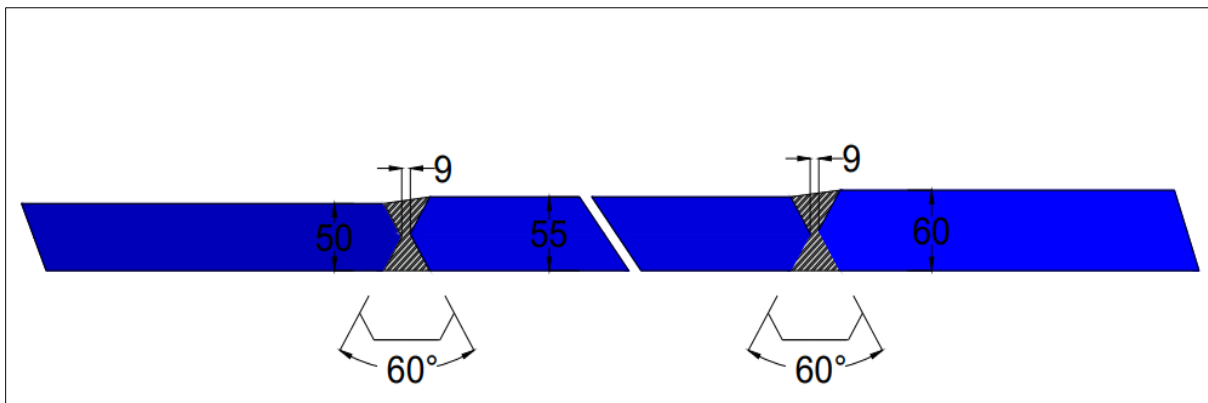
Détail de soudure de la semelle inférieure.
